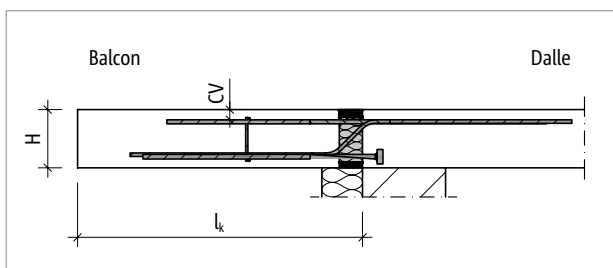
Schöck Isokorb® T type K-T-M13 : système statique
